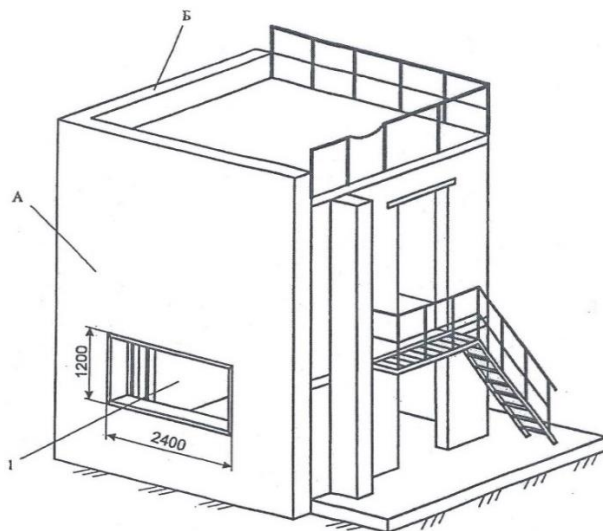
Фрагмент будинку для випробування конструкції зовнішніх стін з фасадною теплоізоляцією з опорядженням штукатуркою та утеплювачем на поширення вогню:
